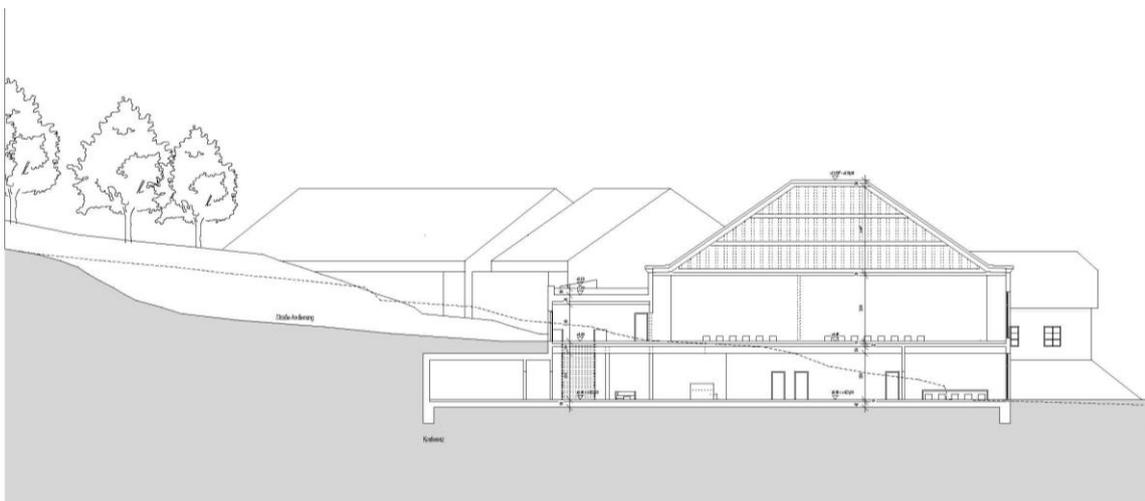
Schnitt EE, Tagungsgebäude, quergestelltes Satteldach mit abgewalmten Giebeln
